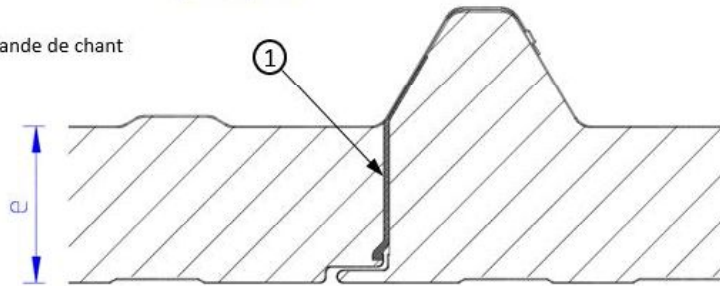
Panneau JI ROOF 1000 D avec emboitement droit
